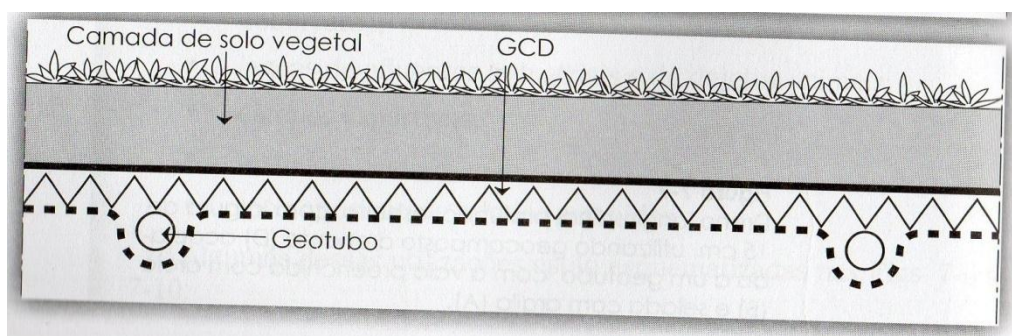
Sistema Drenante Subsuperficial em Campo Esportivo sobre Solo. O Geocomposto Drenante (GCD) Atua como Colchão Drenante, Acoplado a Geotubos Condutores.
